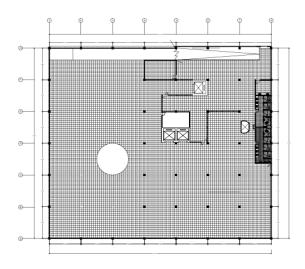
Denah Rencana lantai (Lantai 1) Sumber: dokumen pribadi
